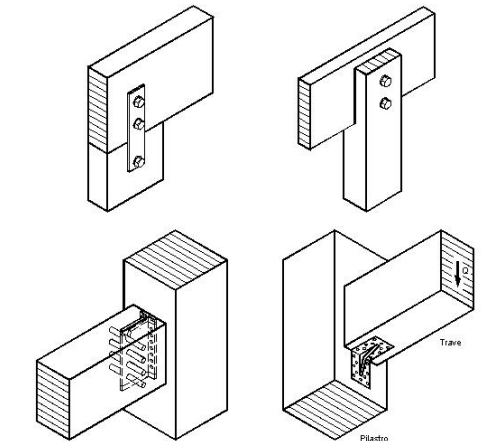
Esempi di collegamento trave-pilastro con vincolo a cerniera
